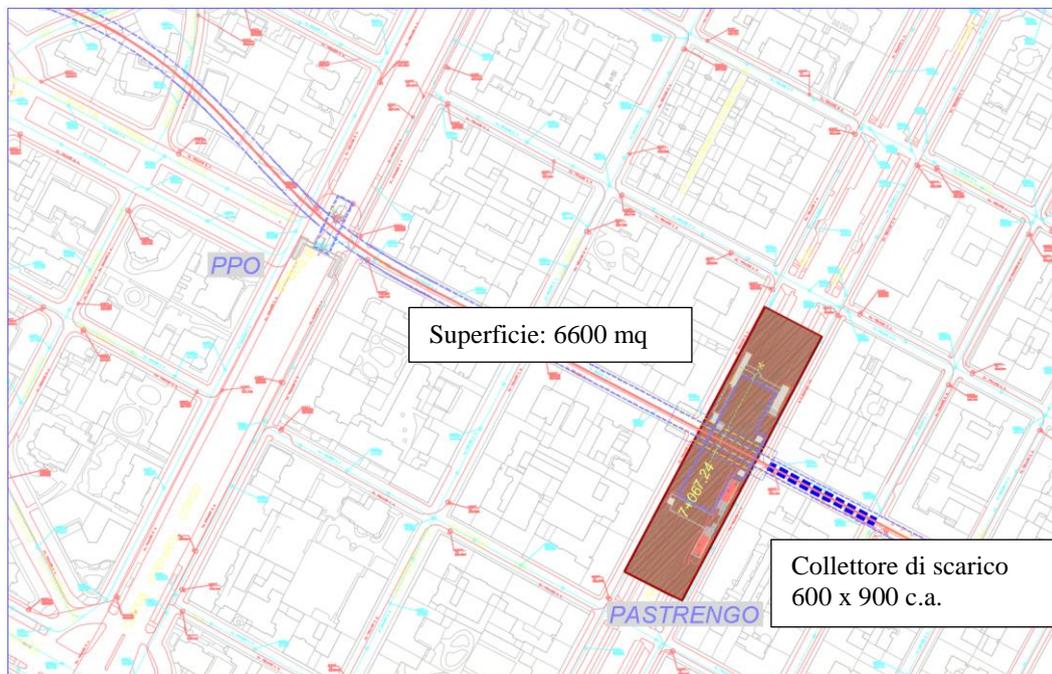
Aree di cantiere – Stazione Pastrengo – FASE 2
